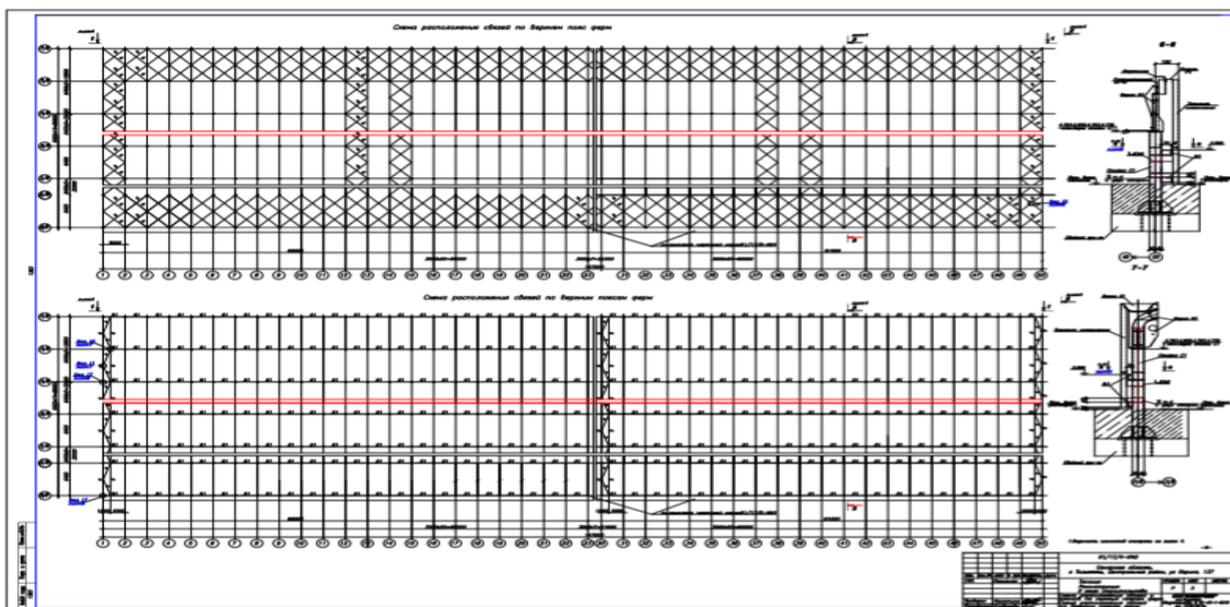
Общая схема расположения связей по верхним и нижним поясам ферм
